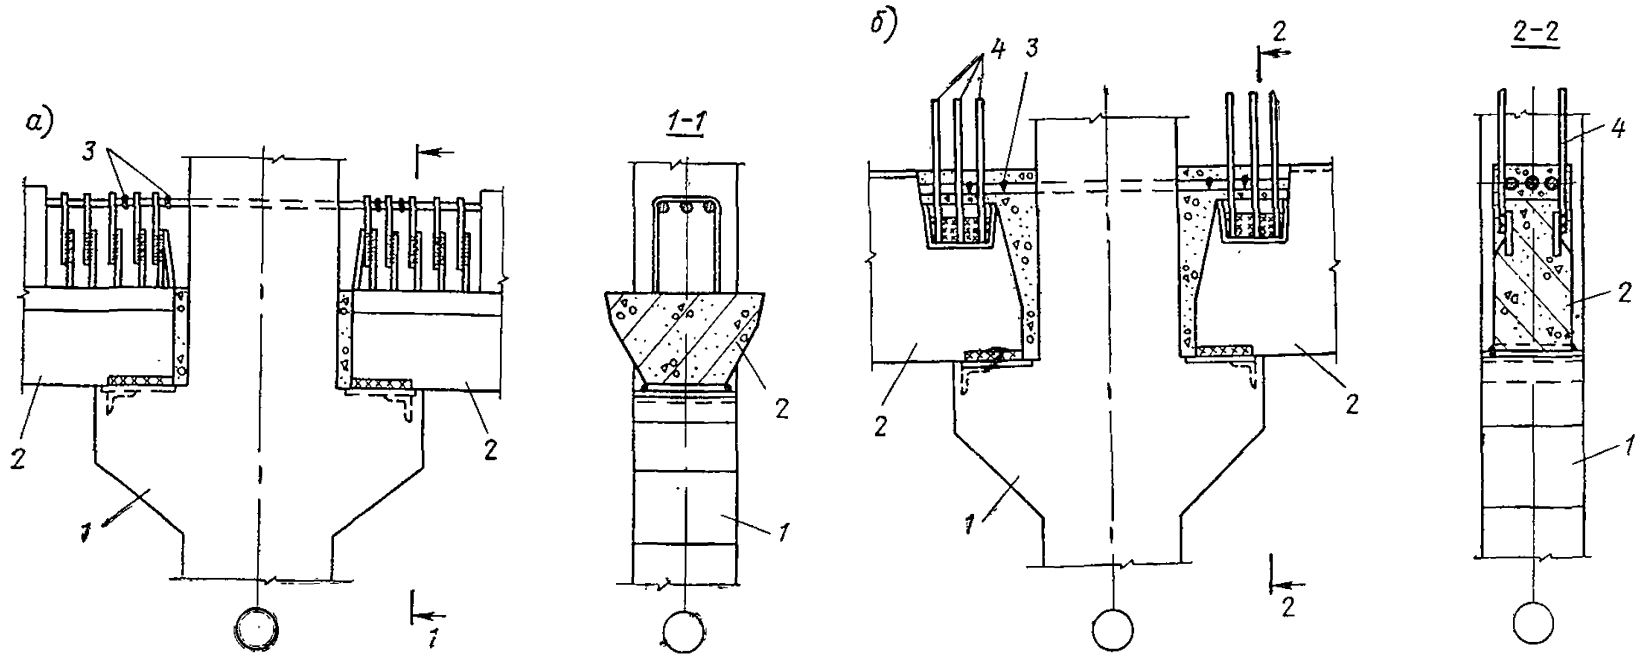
Сопряжение сборных поперечных ригелей перекрытия со средней колонной
